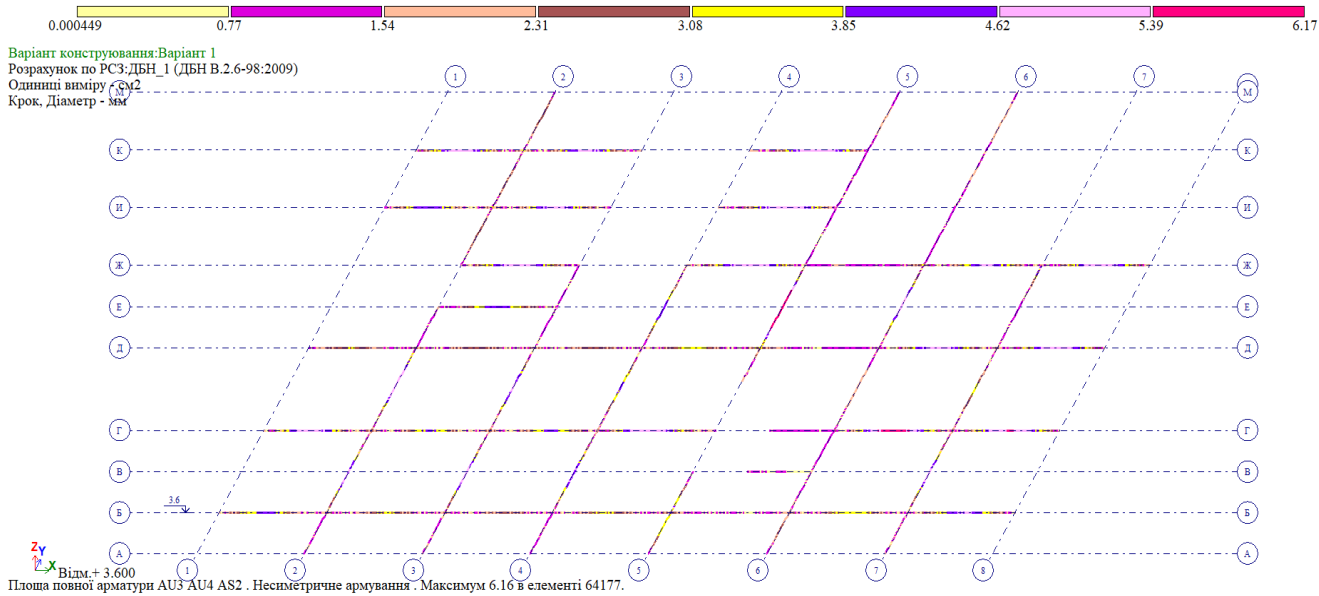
Площа робочої арматури у верхній грані балки Б-2
